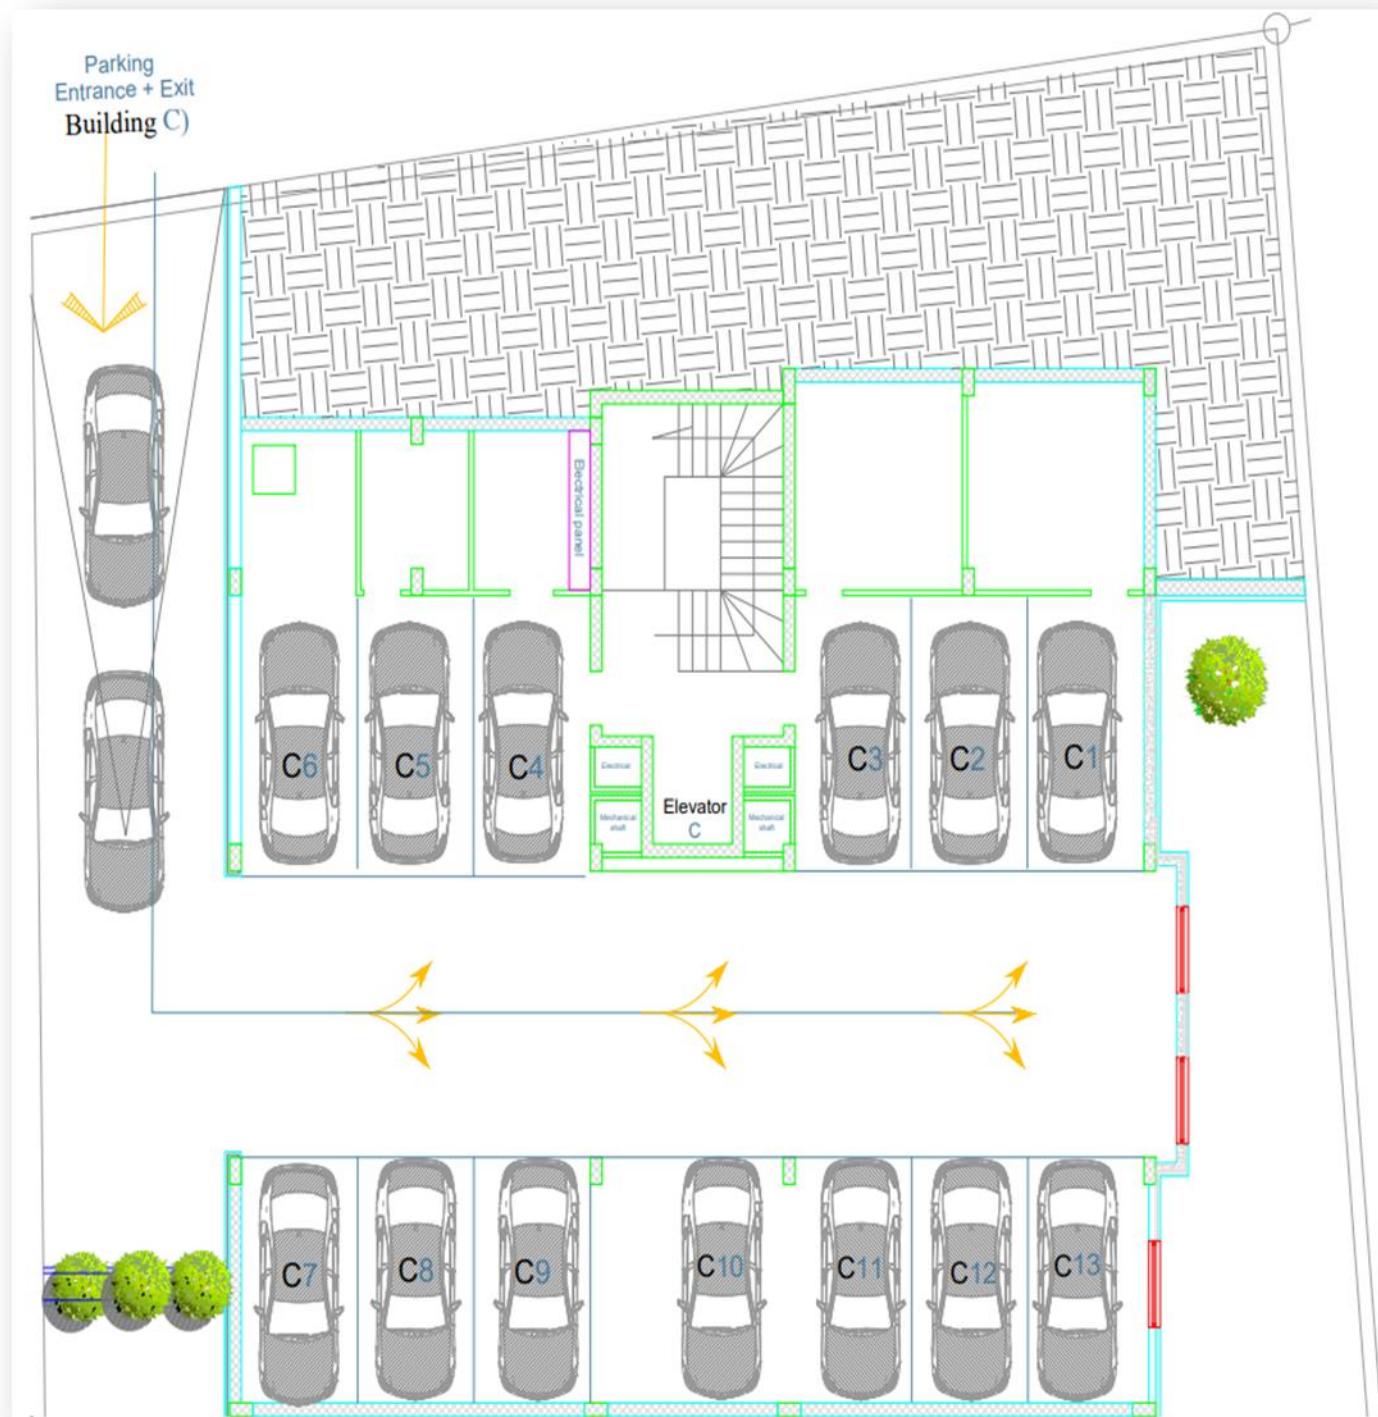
المسقط الافقى لـ 2 Basement Floor
